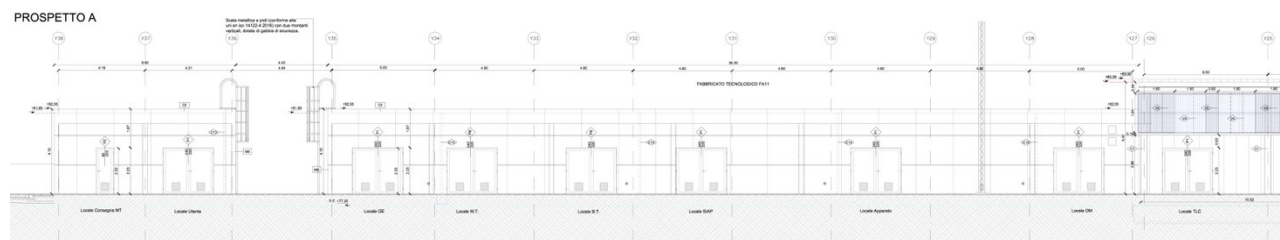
Pianta Prospetto FA11 (fermata San Lorenzo)
